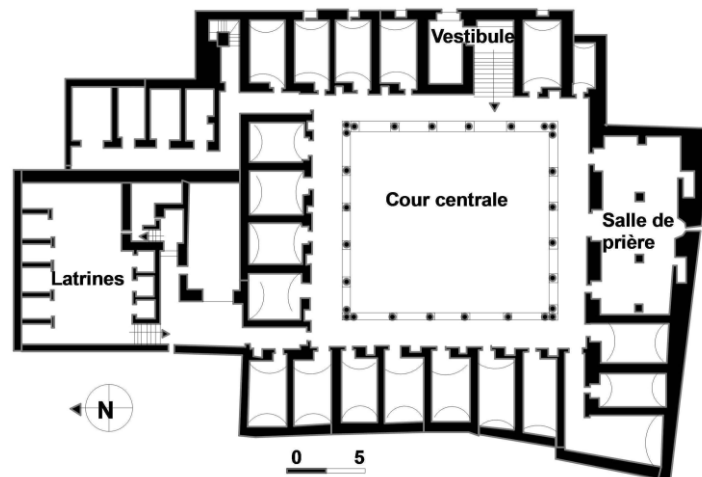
Vue en plan du rez-de-chaussée de la medersa el-<sup>â</sup>chûriya
